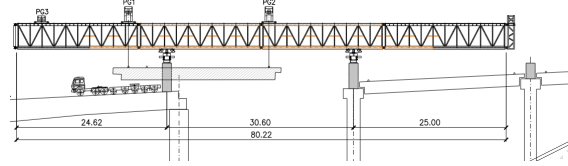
Retirada de las vigas del vano 7 y descenso sobre camión situado en vano 6 del viaducto
